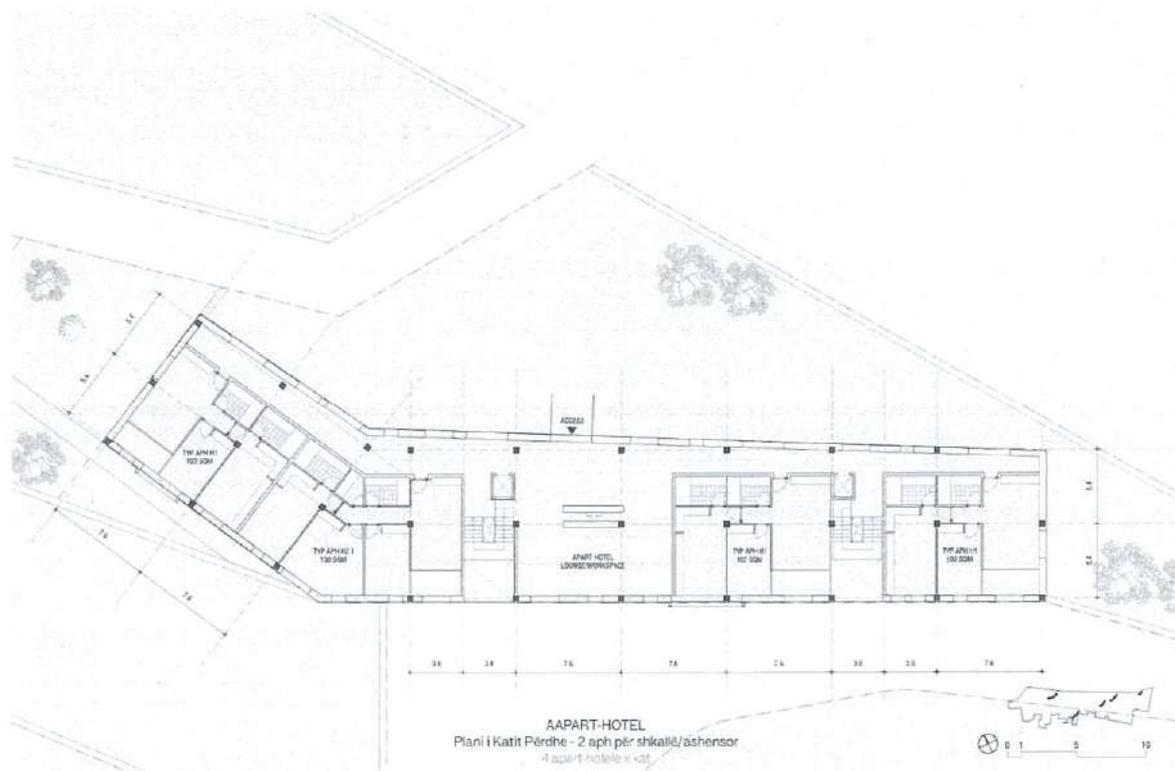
Plani i Katit Përdhe, Apart-Hotel
